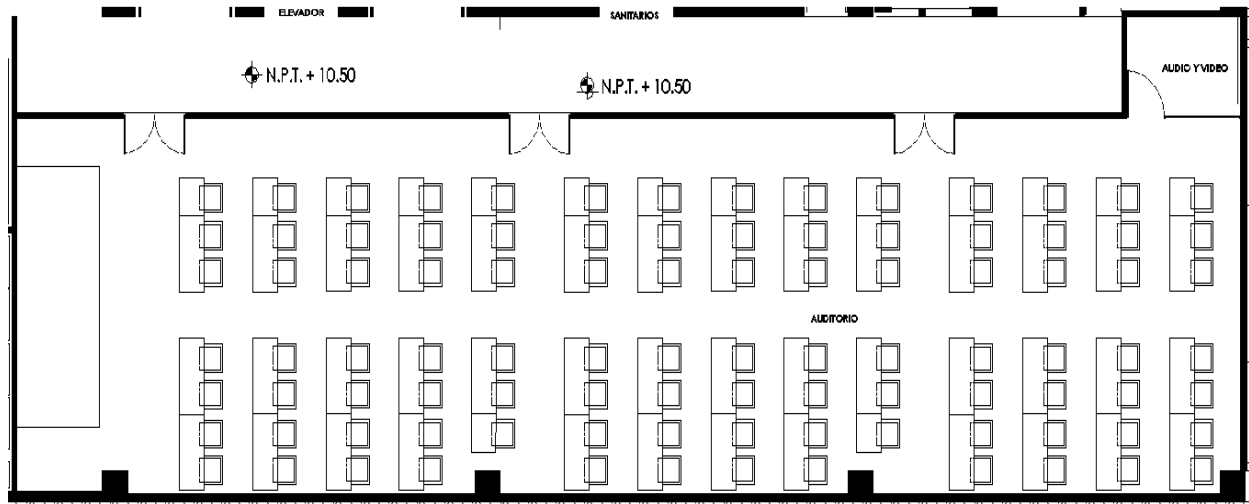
Auditorio (vista en planta). Autor: Eva Zavala.
